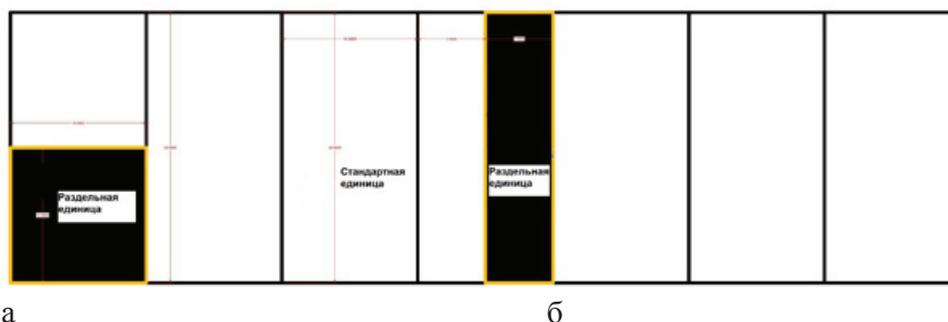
а) схема плана участка с размещением на нем дома «квадратного стиля»; б) схема плана участка с размещением на нем дома «полосатого стиля». Сост. Аль-Шайбани Алаа Абд Али
